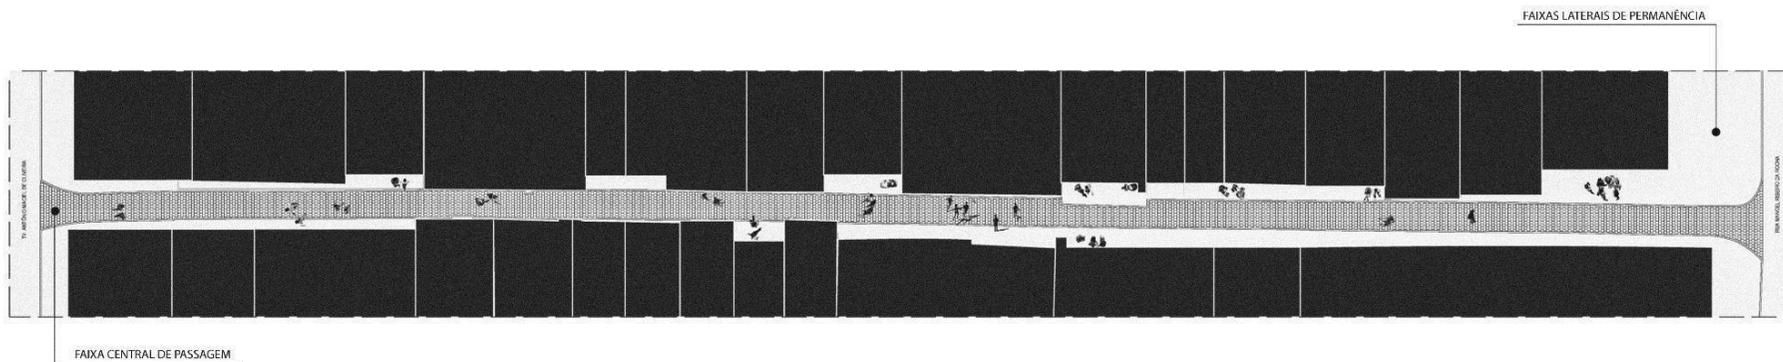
Diagrama em planta baixa da dimensão espacial dos entrelugares da Rua Santa Sofia.
